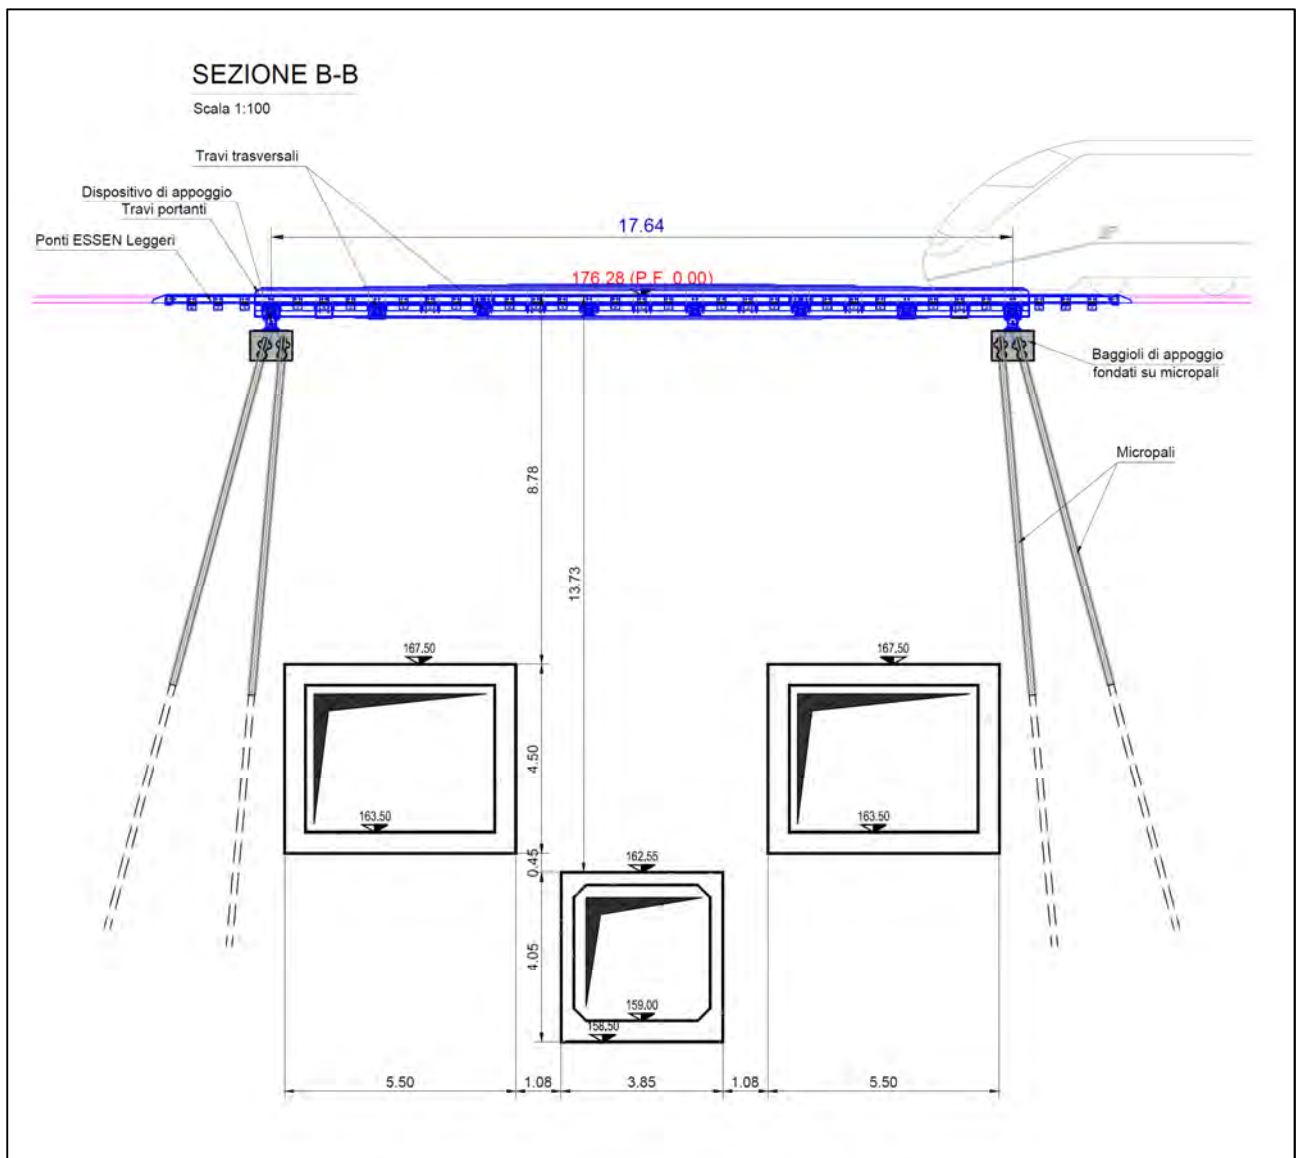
Sezione longitudinale del ponte gemellato Essen
